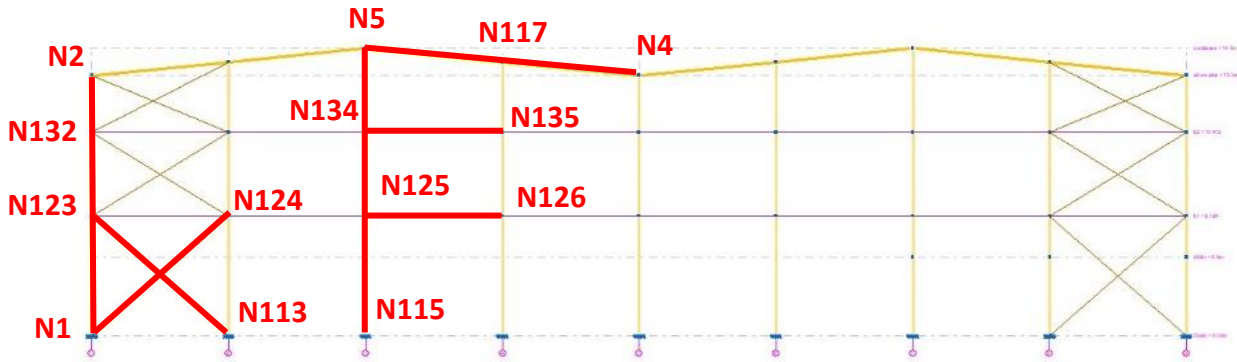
Selección de barras del pórtico de fachada. Fuente: CYPE 3D.
